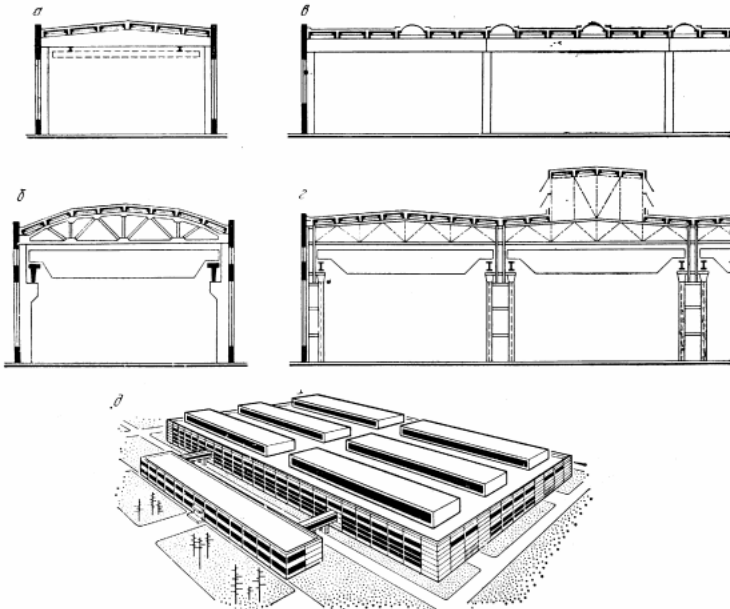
Основні типи одноповерхових промислових будівель: а – однопрольотна безліхтарна; б – те саме, з мостовим краном; в, г – багатопрольотні з ліхтарями; д – загальний вигляд будівлі
